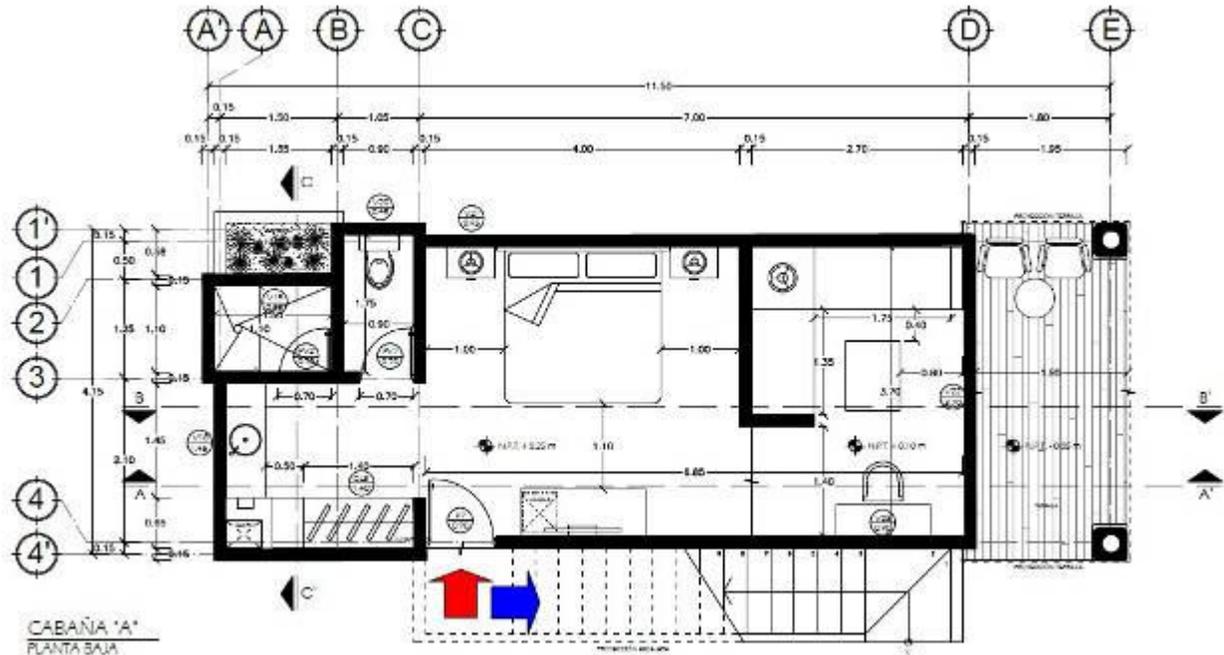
planta de Cabaña Tipo A (Flecha roja: Acceso directo en planta baja. Flecha azul: Acceso a escaleras para segundo nivel.)
